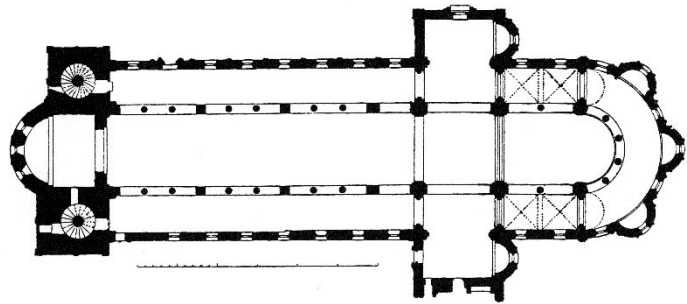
Grundriss von St. Godehard in Hildesheim
